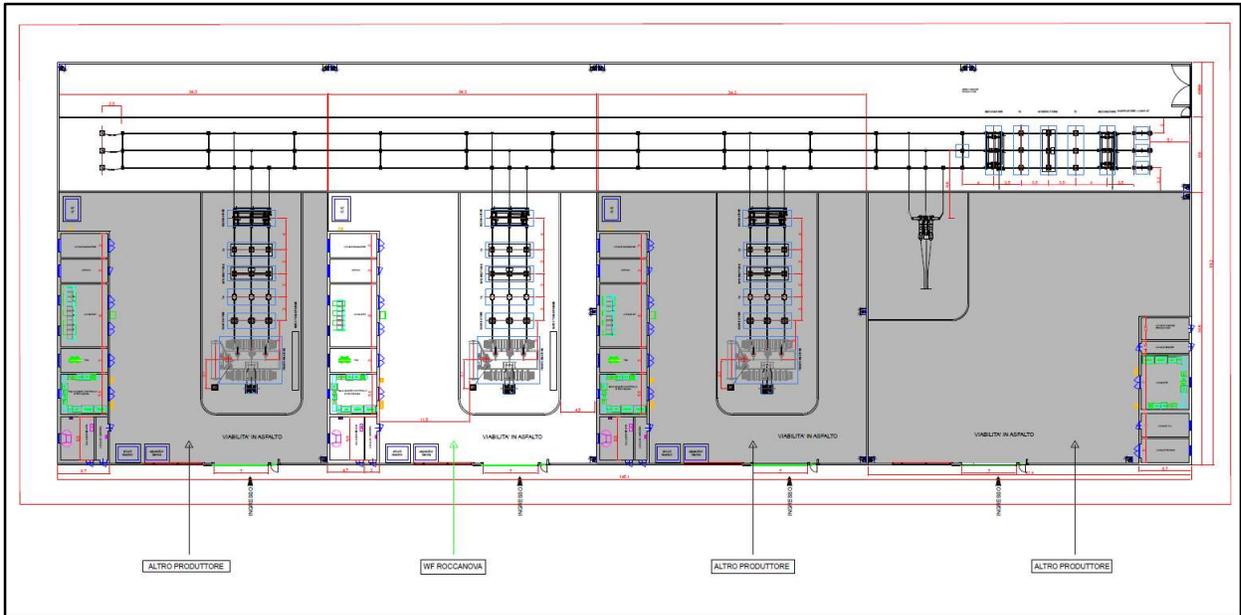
Layout della Stazione Elettrica Utente 150/33 kV (SEU)
